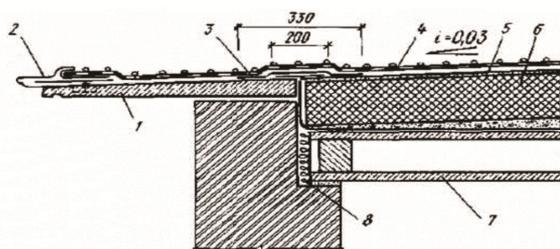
Схема совмещенного неветилируемого покрытия с гладким потолком и наружным водоотводом
